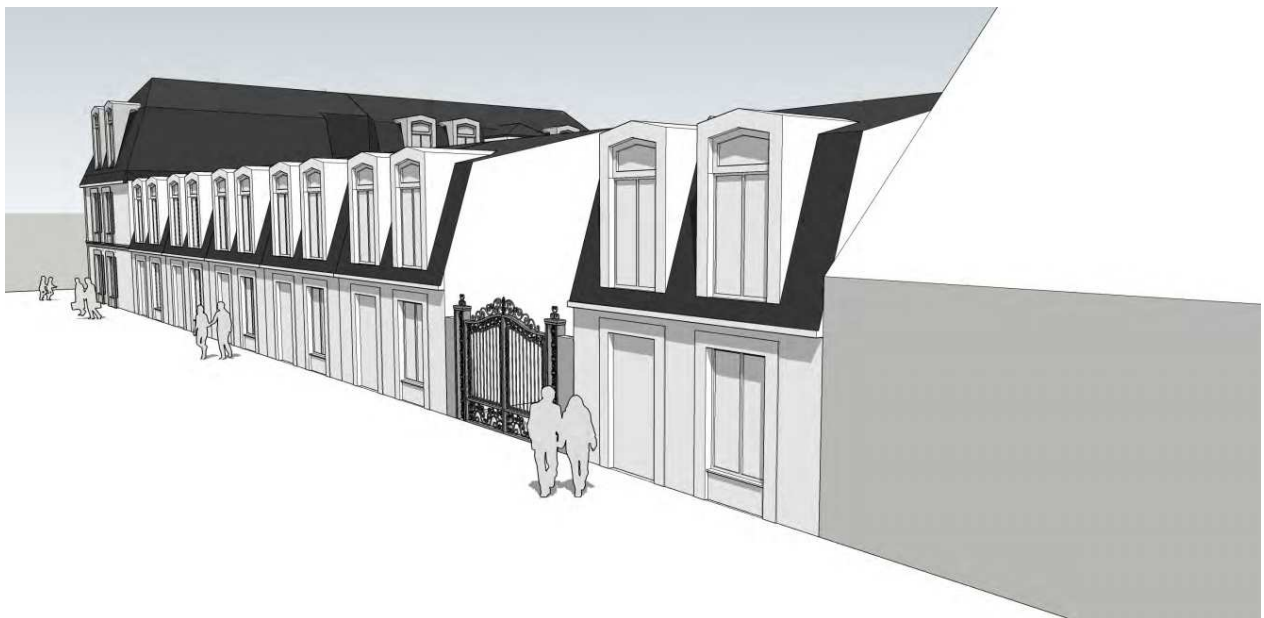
Ansicht der Straßenrandbebauung Marstallstraße
